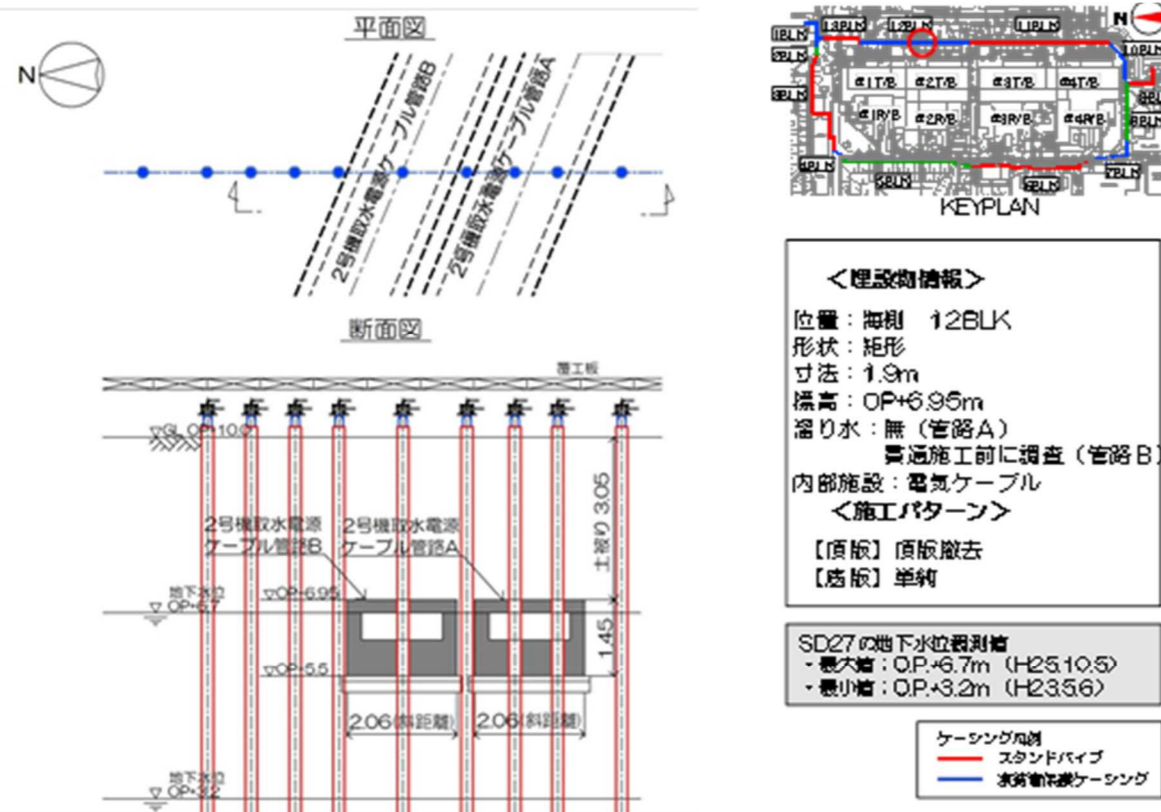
【12-4】2号機取水電源ケーブル管路A,B 施工方法 (貫通施工)
